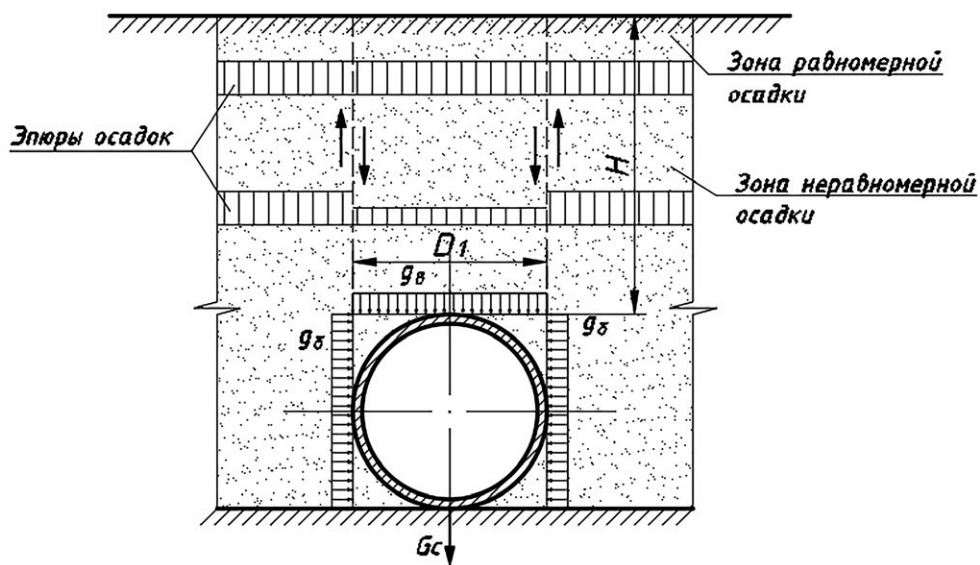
Расчетная схема действия нагрузок на трубу в насыпи
